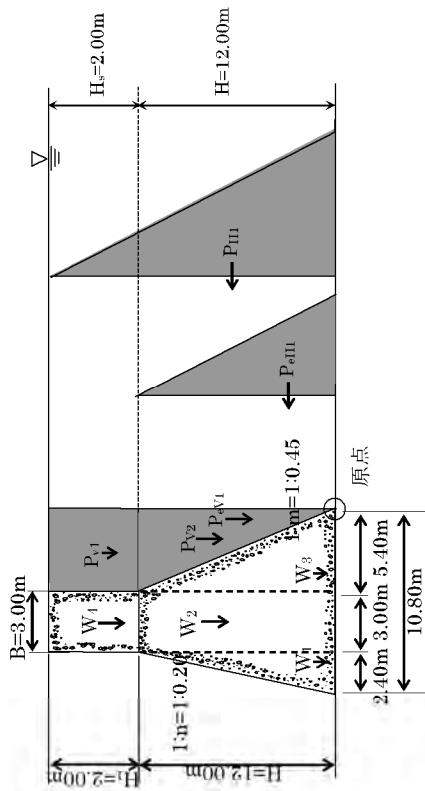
砂防堰堤に作用する力 (断面 (3) : 土石流捕捉後の湛水時)
